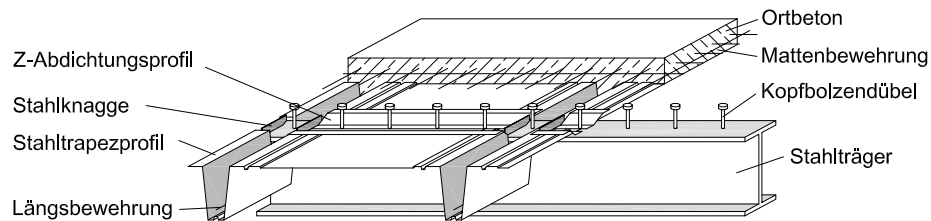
Slim-Floor-Decke (*System Additiv Decke, Hoesch*)
